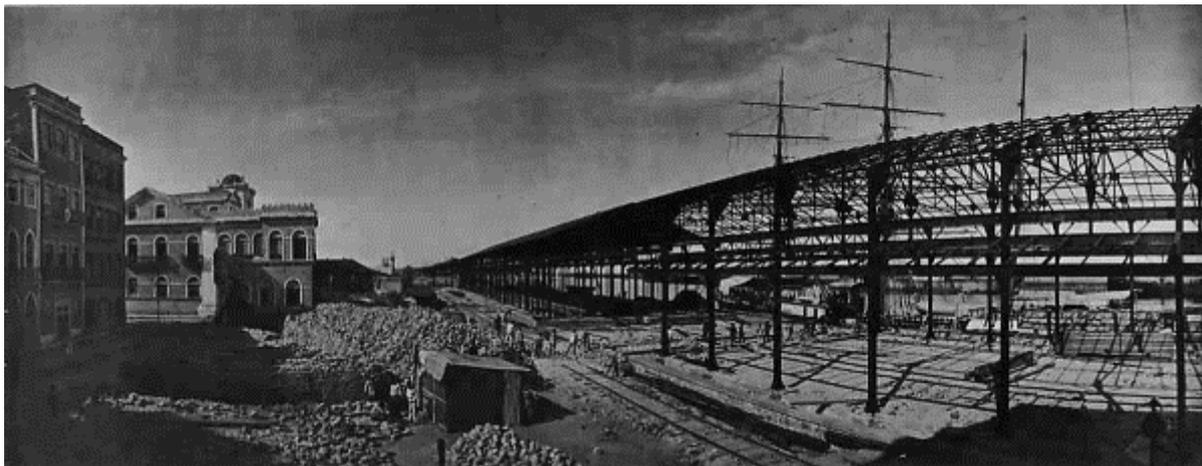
Construção de Armazém: Armazém; Construção; Obras do porto; bairro do Recife³⁶⁶.
